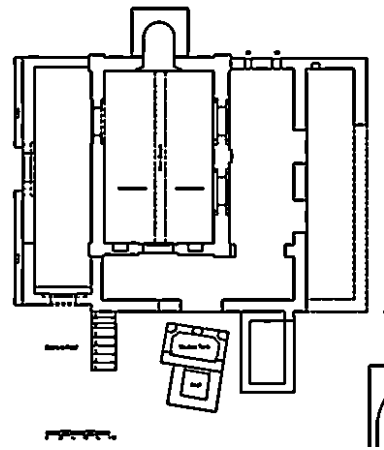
مسقط أفقي لمسجد موانا ذو القباب المخروطية/كينيا
